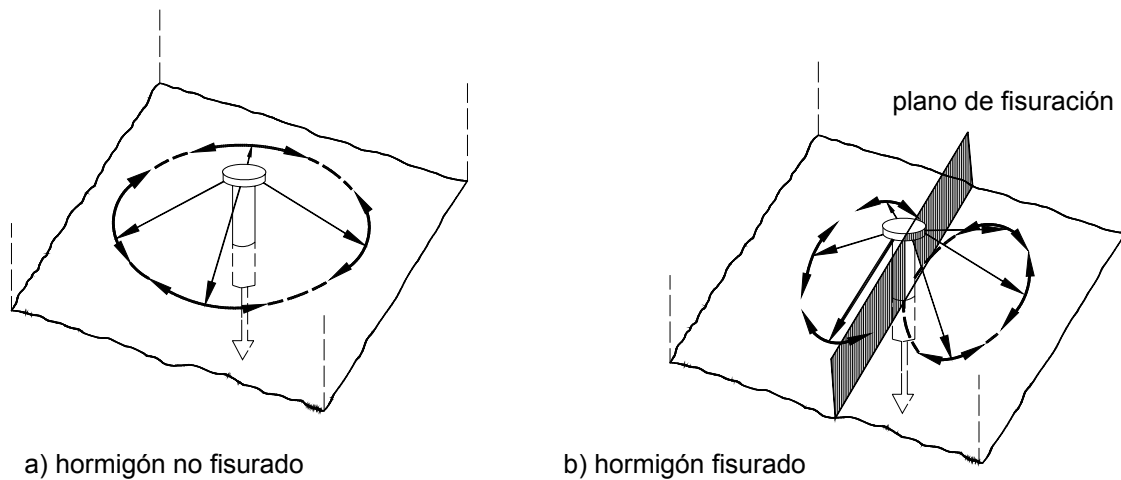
Representación esquemática de la transferencia de carga al hormigón para a) hormigón no fisurado y b) hormigón fisurado (Eligehausen, Fuchs y Mayer, 1987, 1988)
